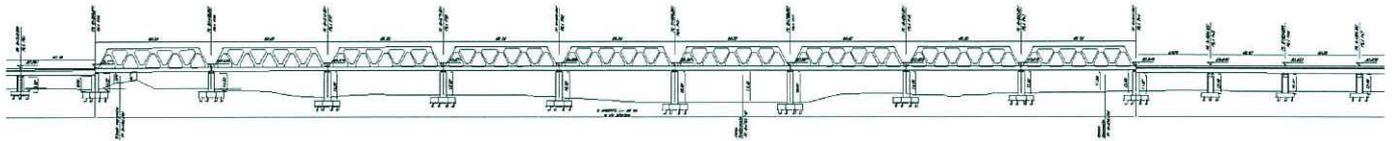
Prospetto della campata di scavalco del fiume e di quelle adiacenti.
